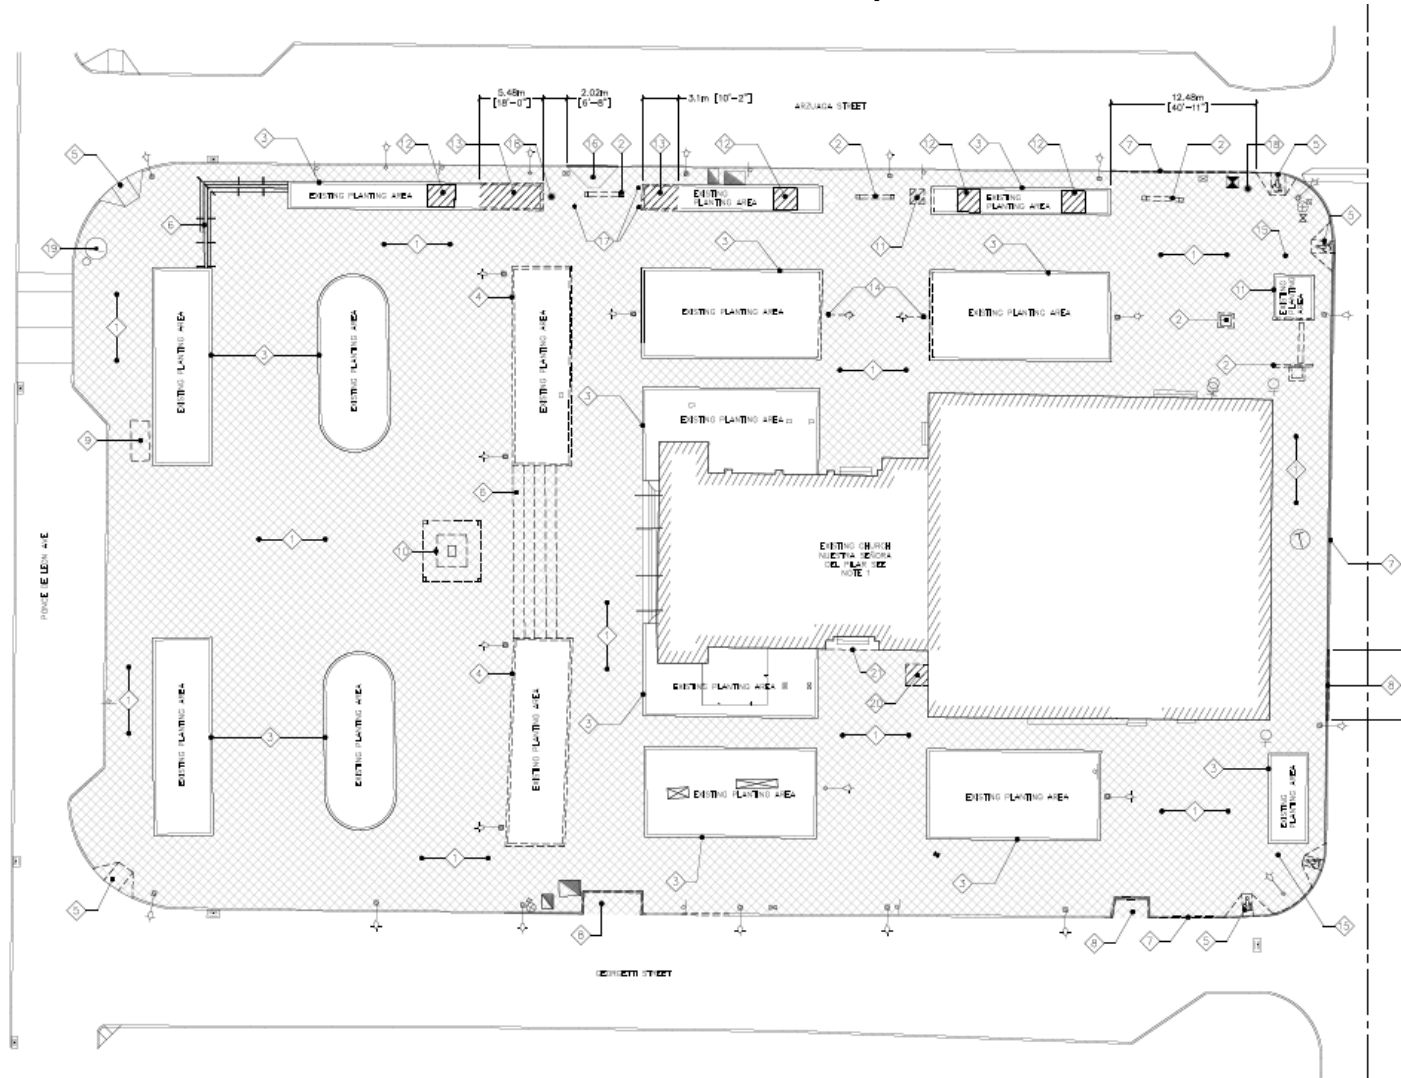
Plaza de la Convalecencia. Demolition site plan. (Source: Drawing DS-1.2, Hernández-Bauzá PSC Architects, 2024)
